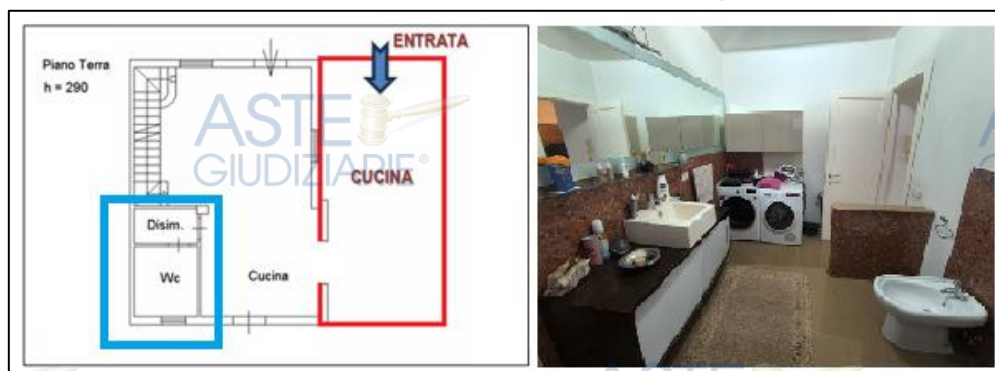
ABITAZIONE IN VILLINO – DISIMPEGNO/BAGNO IN DIFFORMITA' ALLA PLANIMETRIA IN ATTI
